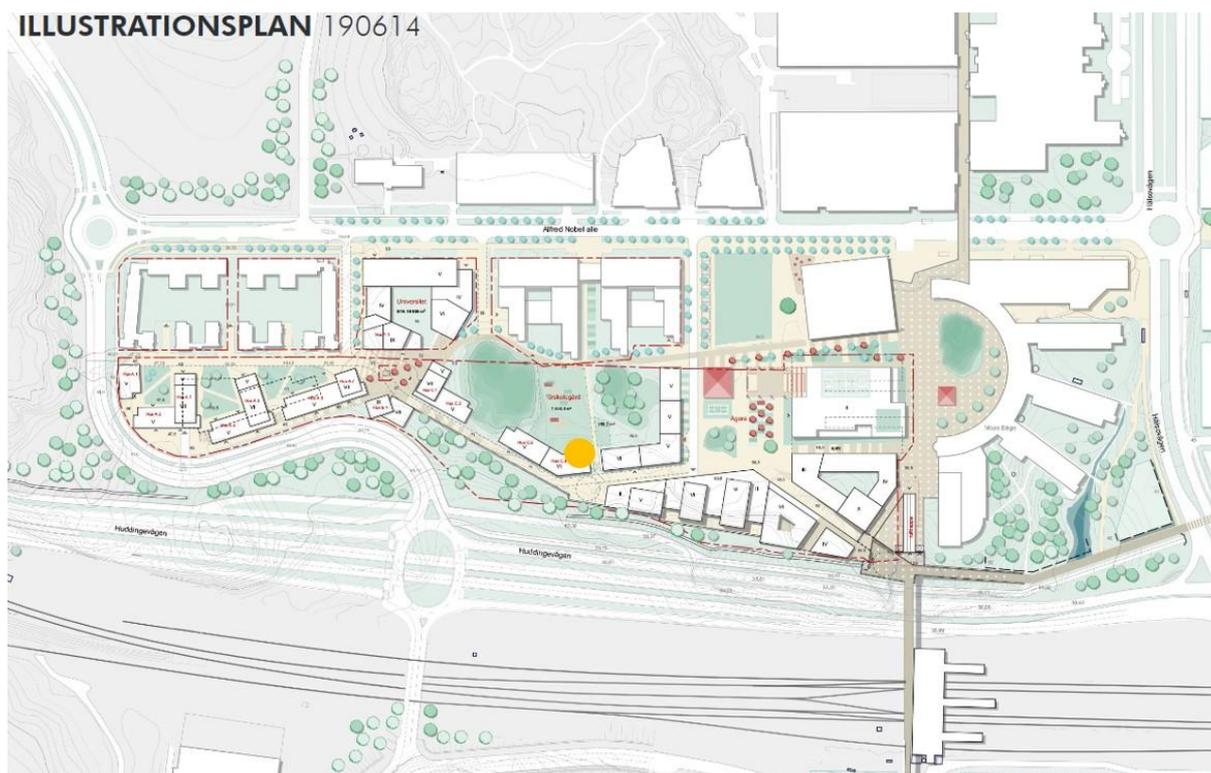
Planområdet (grönstreckad markering) och närliggande större målpunkter.
